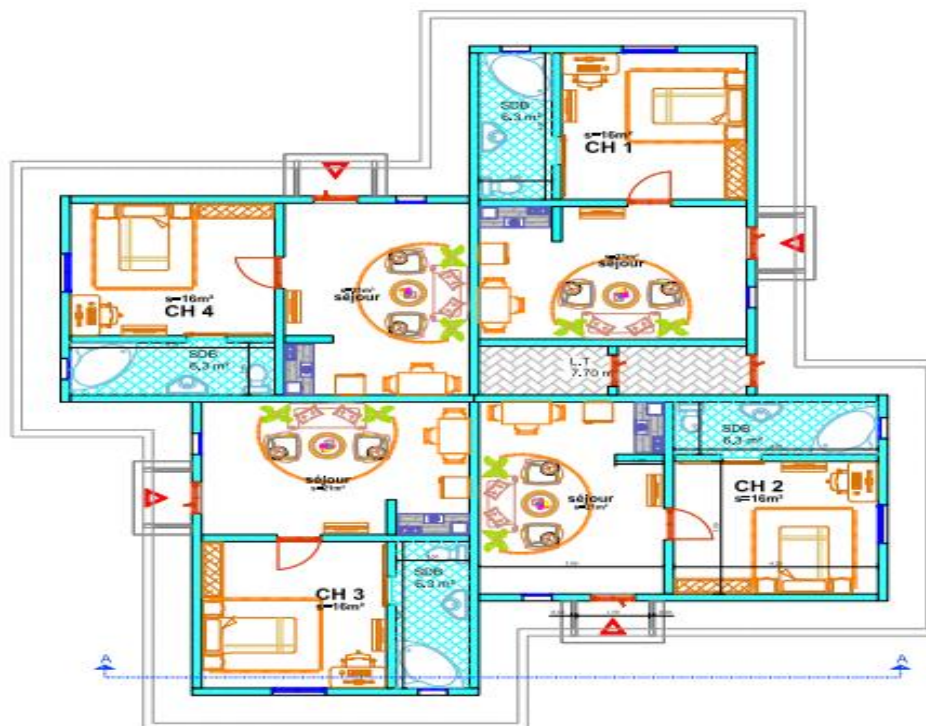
Plan du BLOC VIP Situé à GASSI TOUIL
